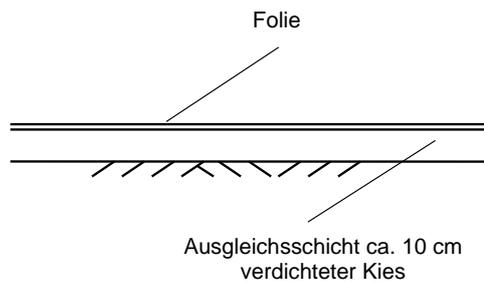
Massnahmen bei geringen Anforderungen an die Untersicht
